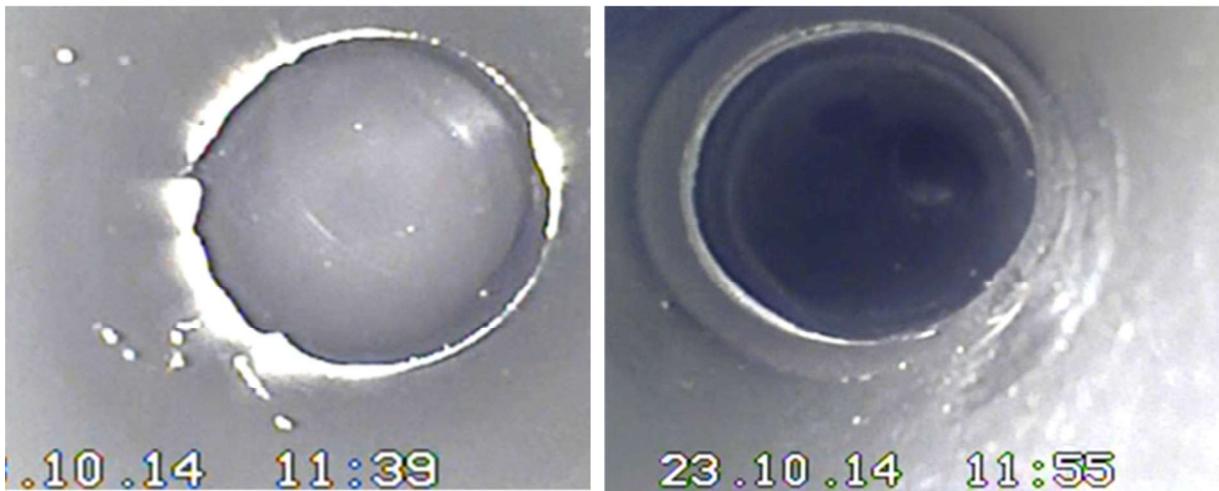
Unterscheidung zwischen Verschweißungen (links) und Verschraubungen (rechts)
